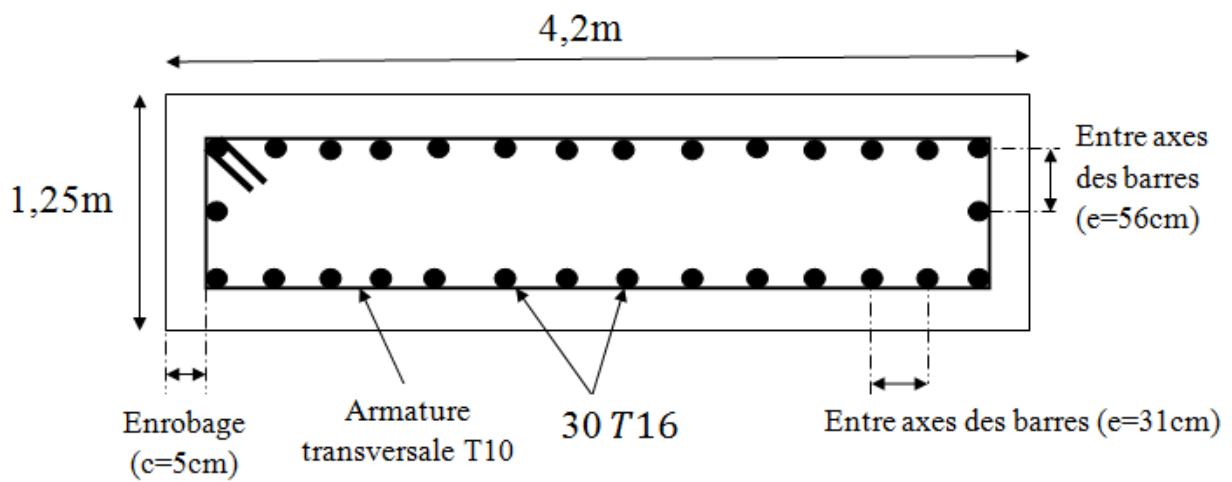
Détail de ferrailage de la poutre de couronnement.
